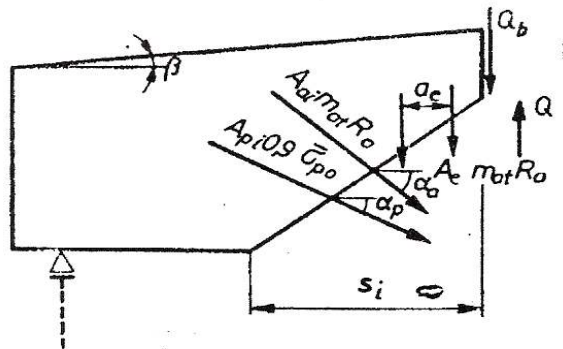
Secțiunea înclinată fisurată.Calculul în starea limită de rezistență la forță tăietoare. [1.4]
